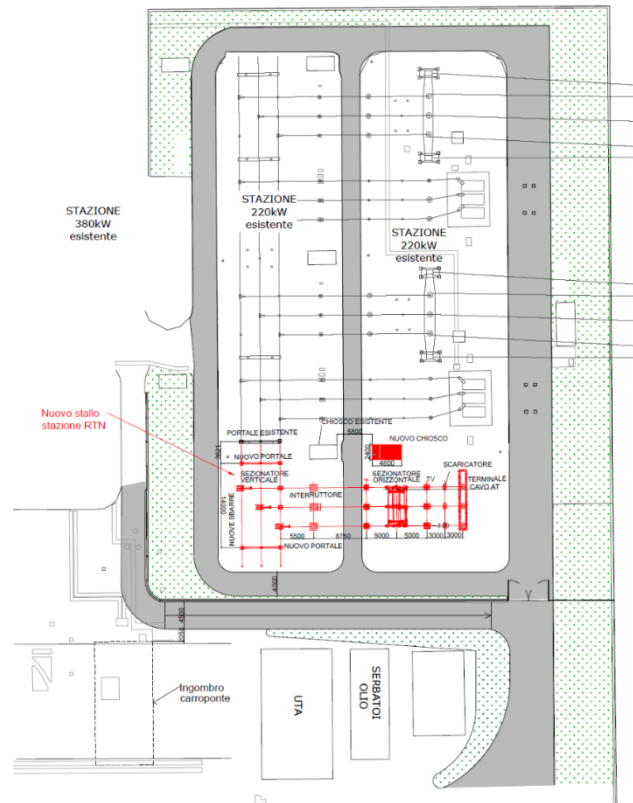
Planimetria Interventi Opere di Rete- Lay Out post-intervento SE RTN 220 KV "Presenzano"
